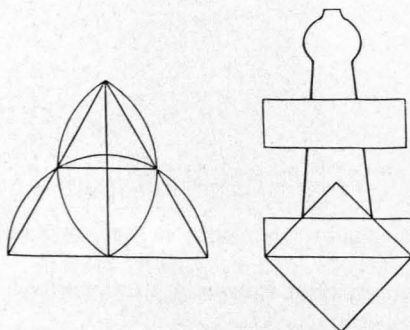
Grundriß eines Hallenchores (Wien Ak. 16923).
